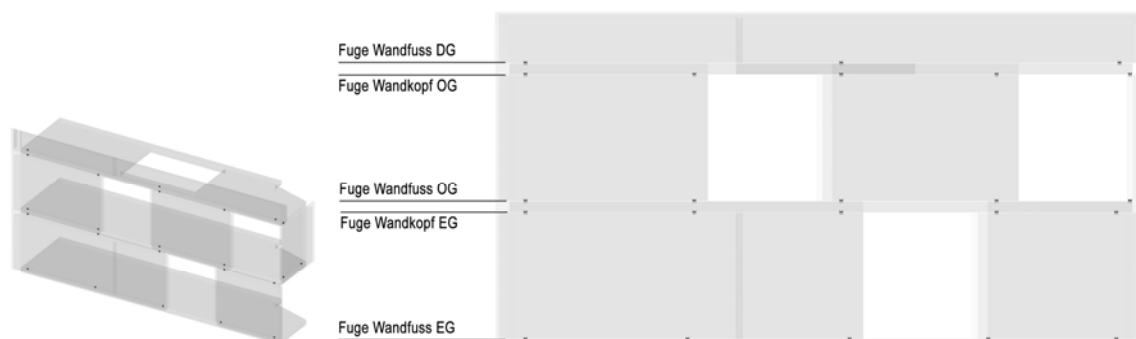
Wandaufbau Prototyp: zwei Stockwerke und Dachgeschoss mit optimiert platzierten PowerClips
